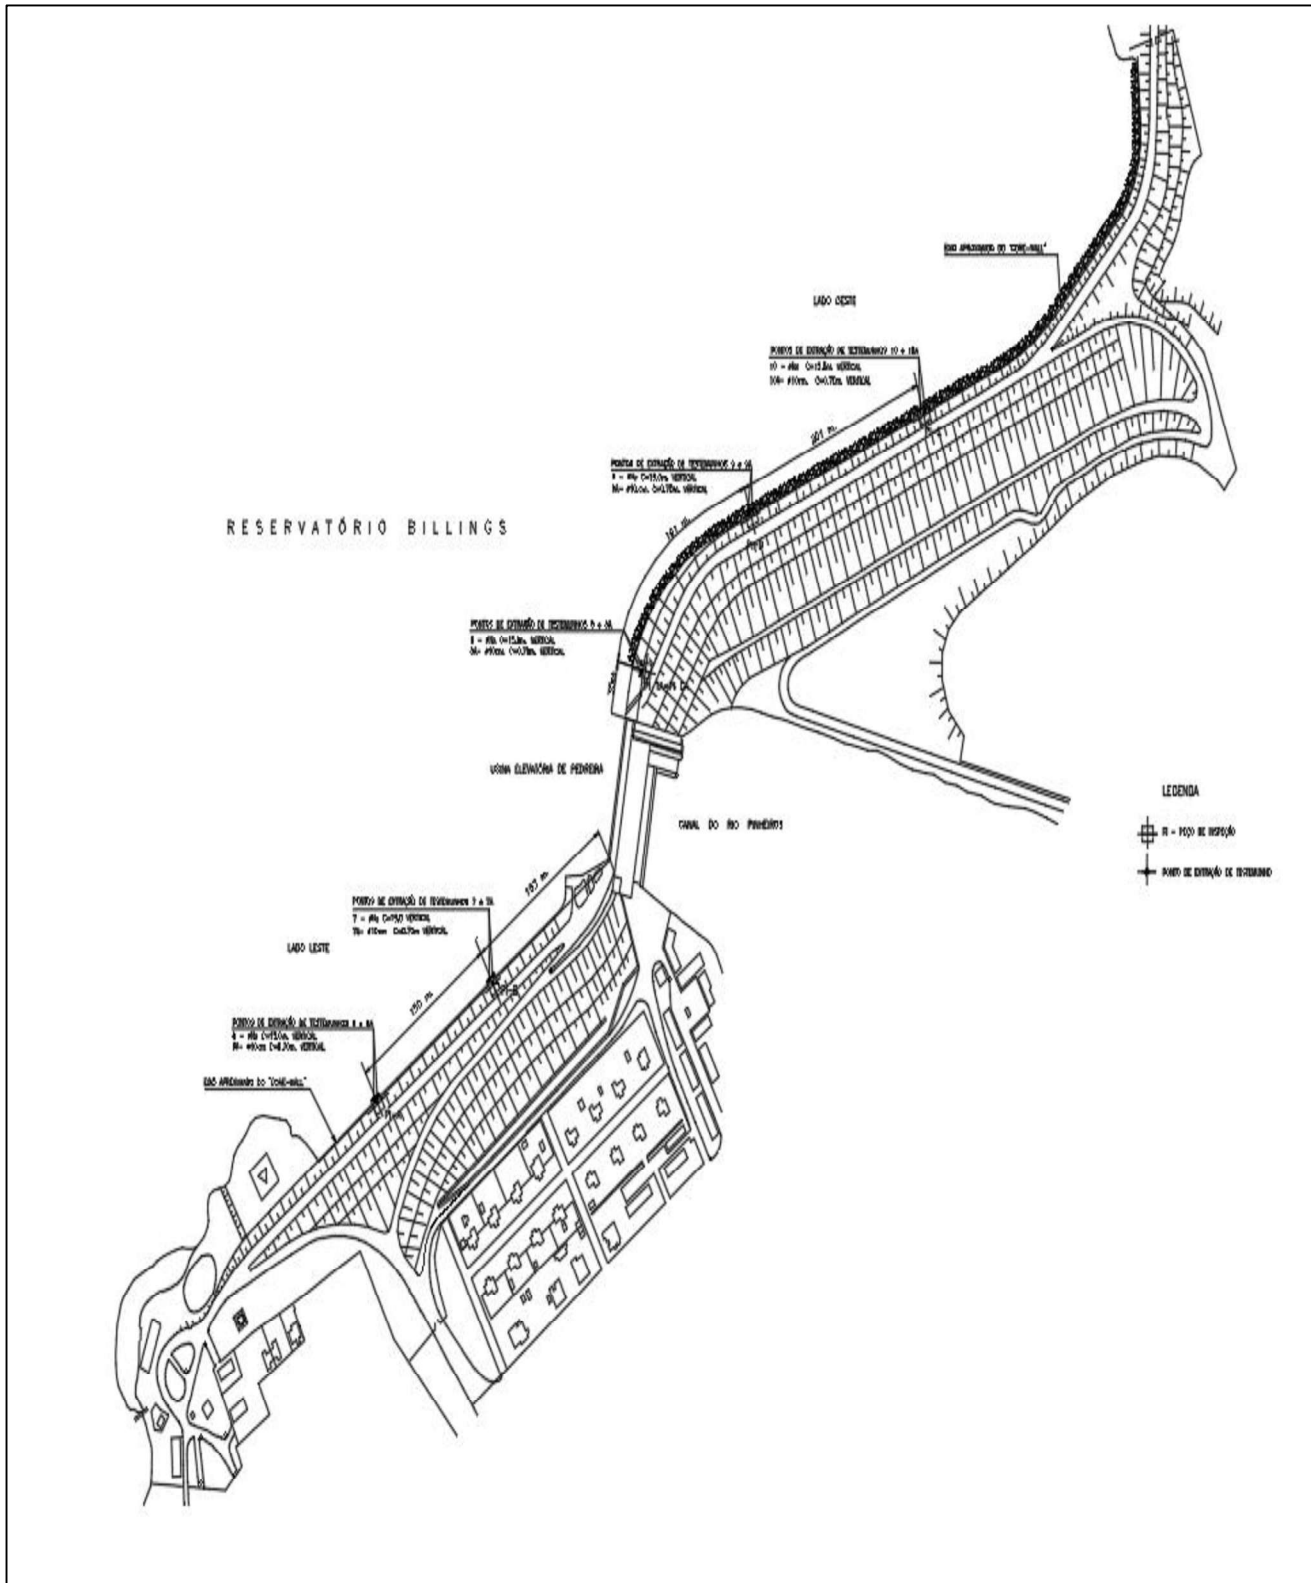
Planta da Barragem do Rio Grande e Usina Elevatória Pedreira.
